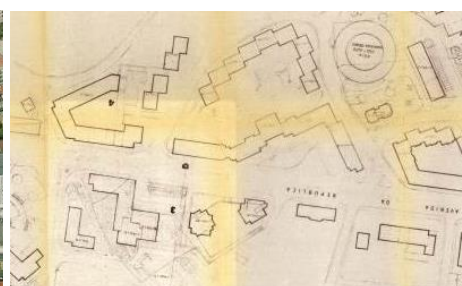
| Pormenor da Planta Geral da Zona Alta da Avenida, (1989)
